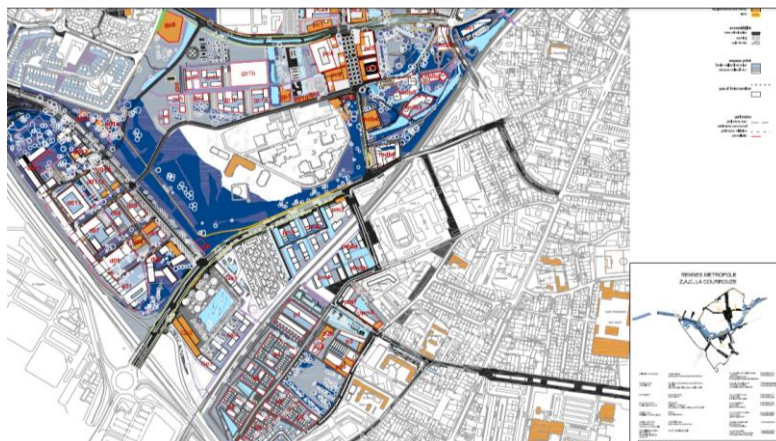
ZAC La Courrouze – Plan de masse avril 2017
